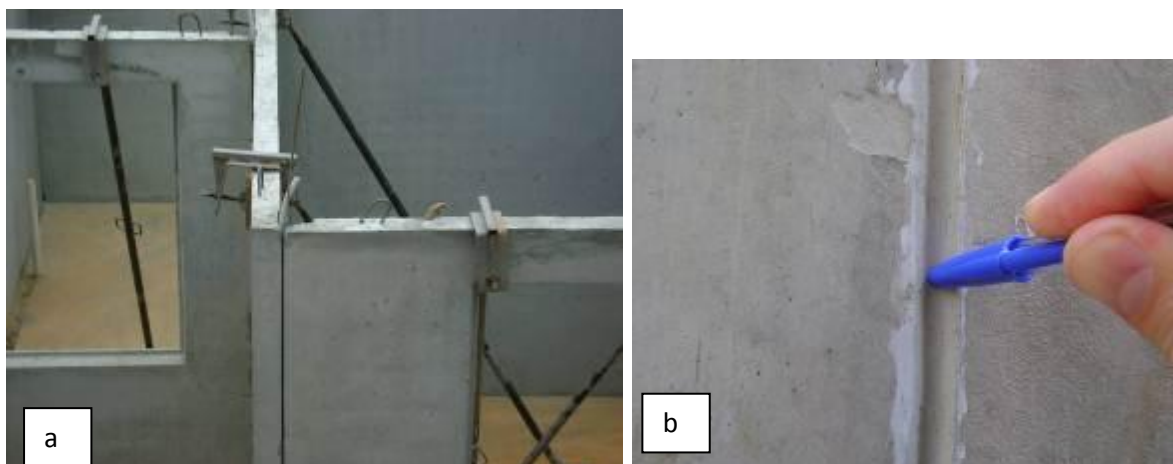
Juntas entre componentes de painéis pré-fabricados de concreto armado do Sistema Rossi – DATEC 007. Encontro de topo entre dois painéis (a), solucionado com o uso de selante (b).
